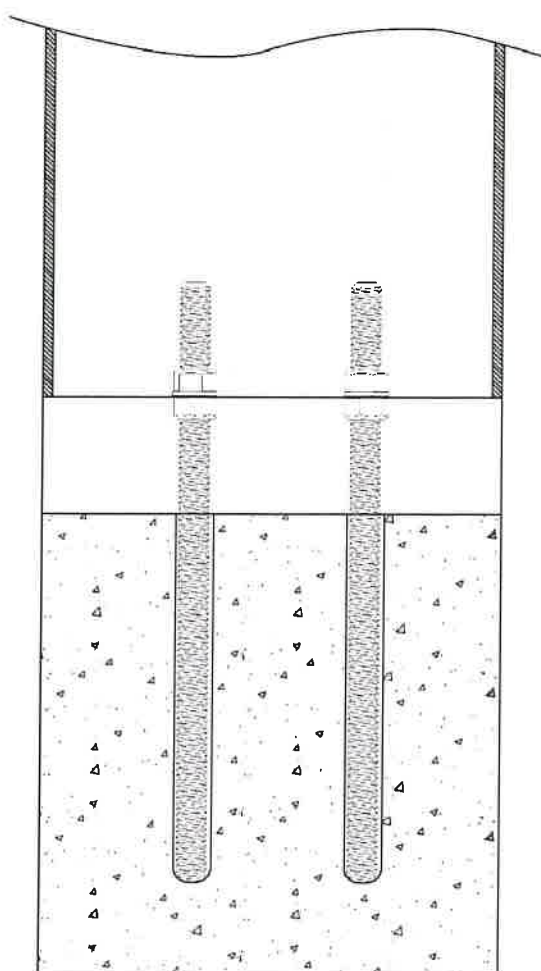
Montagem parquímetro sobre o suporte inferior de fixação.
